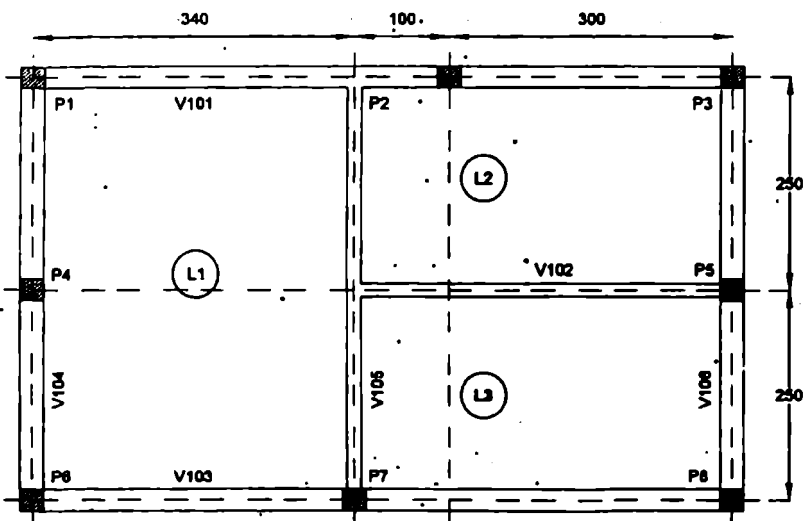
Planta de fôrmas do pavimento do exemplo 4.
